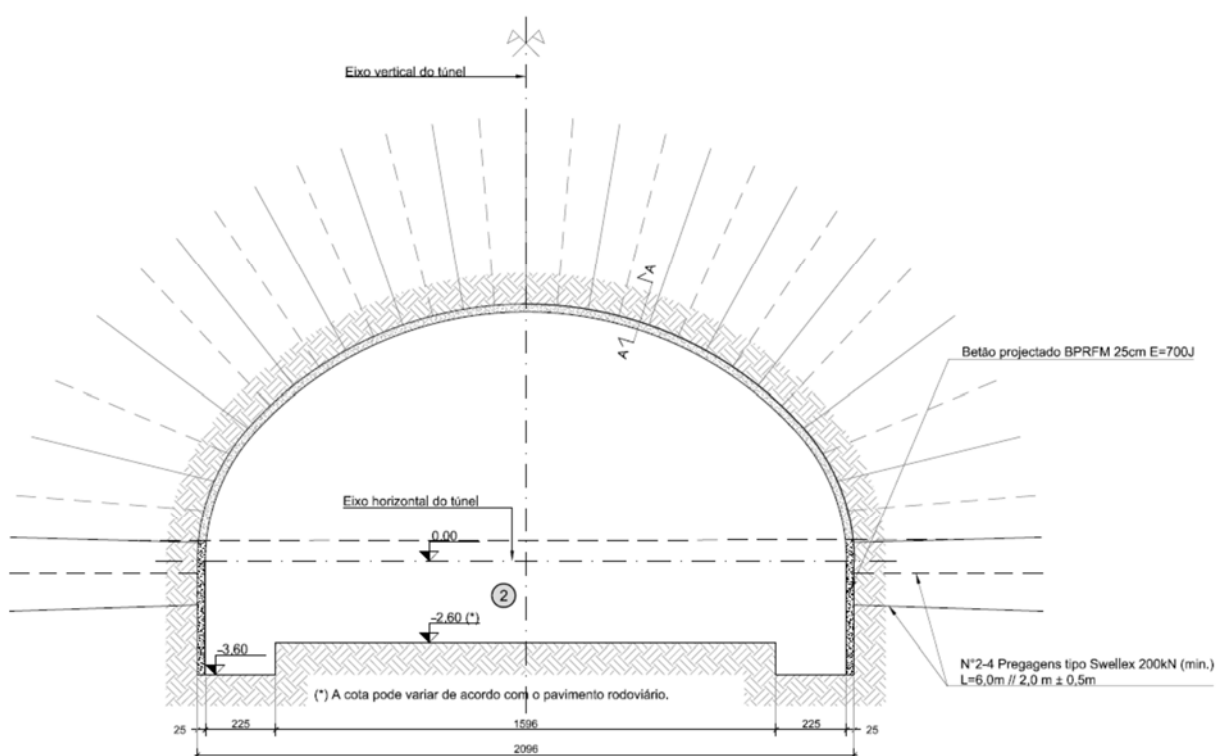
Seção tipo da fase 2 – escavação e suporte primário em ZG1
